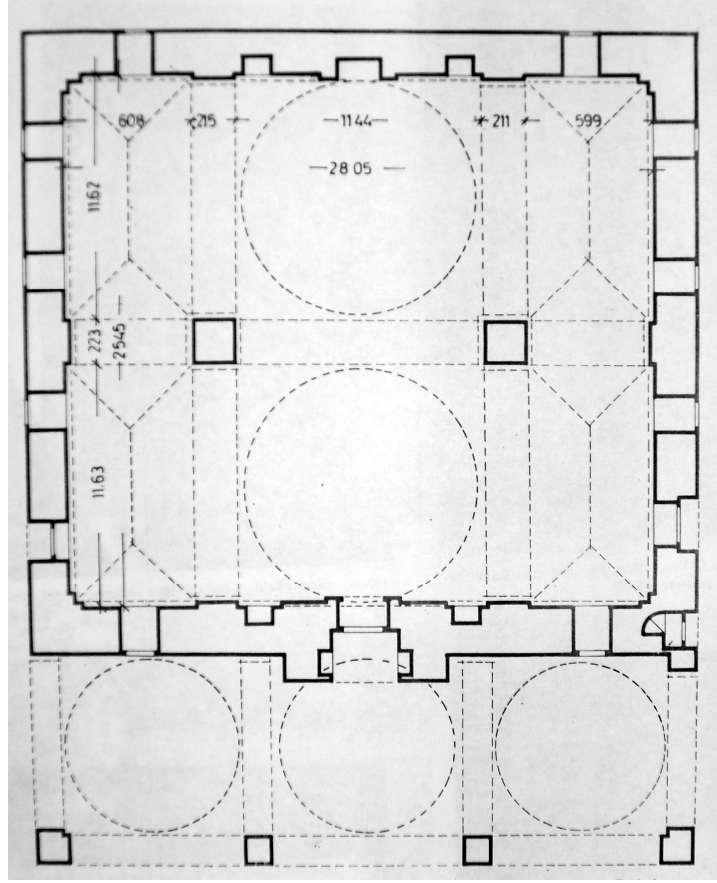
Dimetoka Çelebi Cami Planı (Ayverdi 1989)
